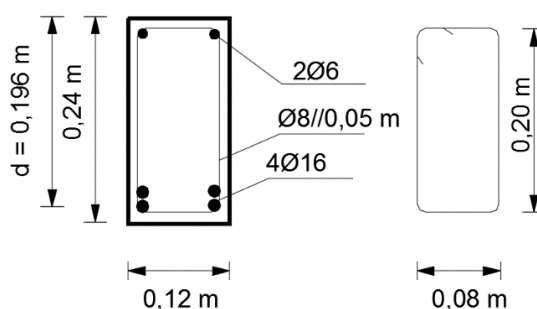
Corte transversal de viga-tipo – ensaio ao corte
